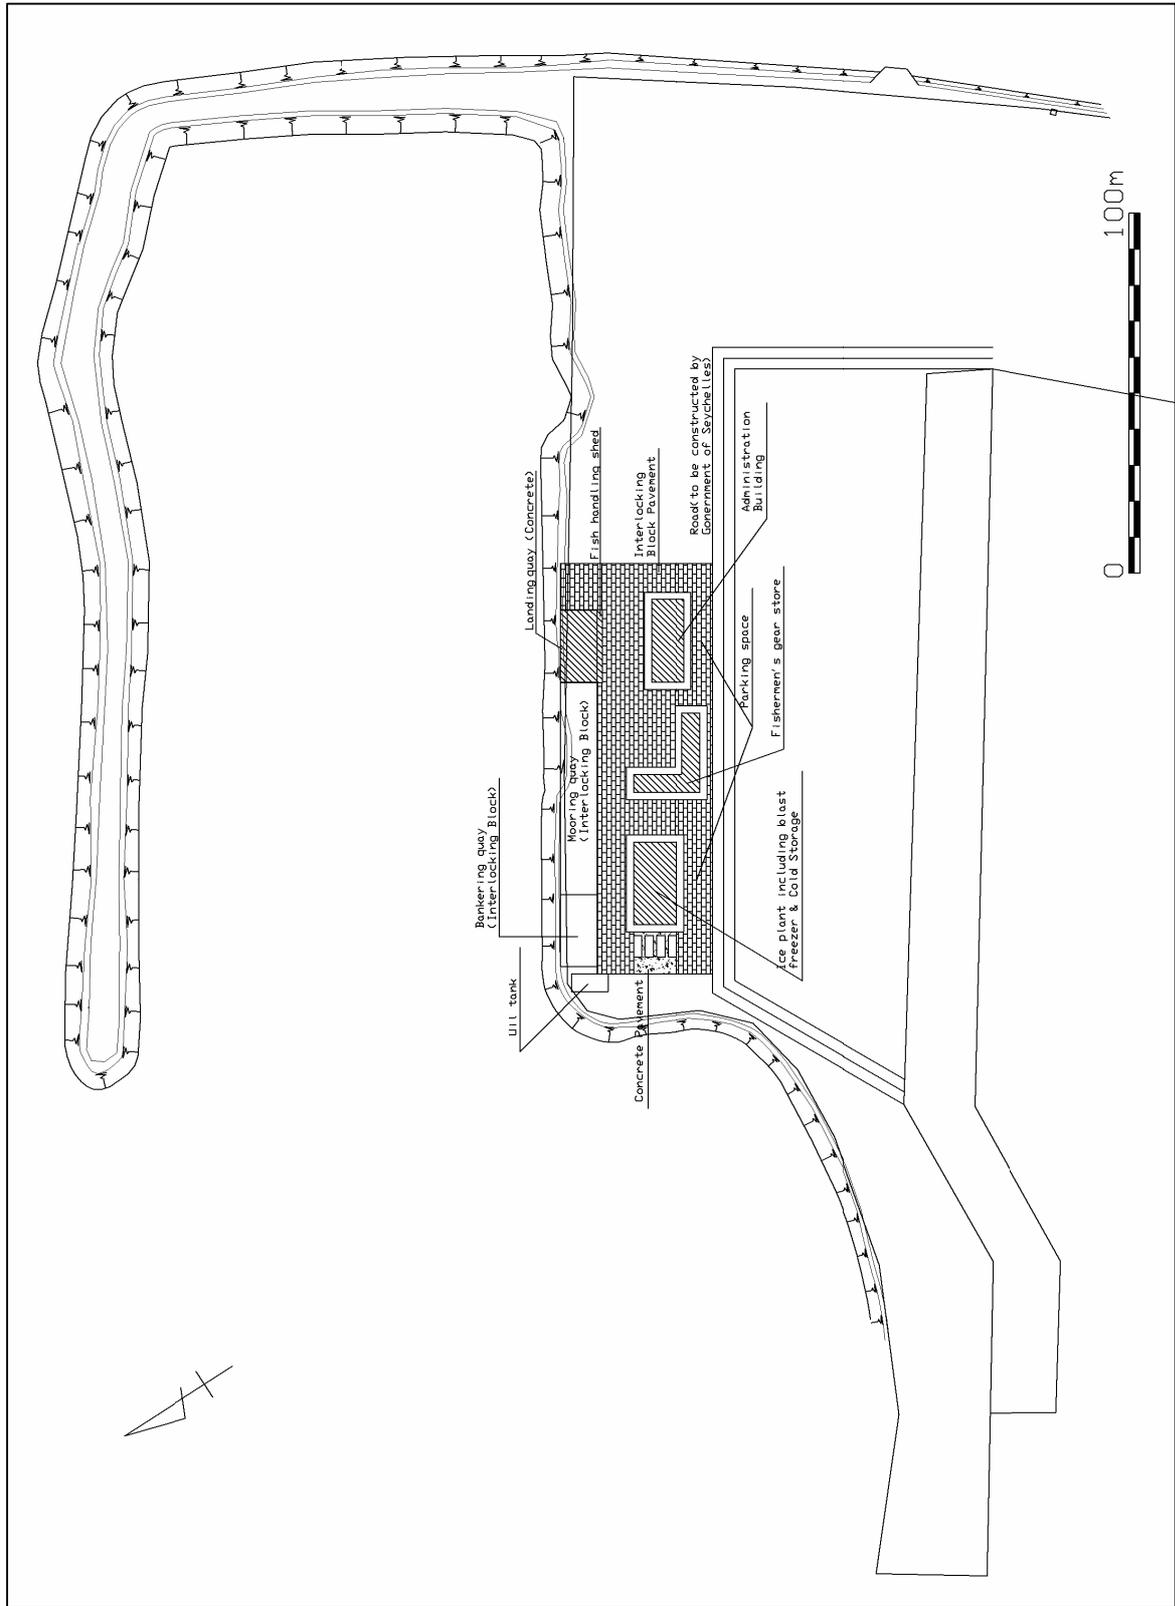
(1) 計画平面図 (プロビデンス漁港)
